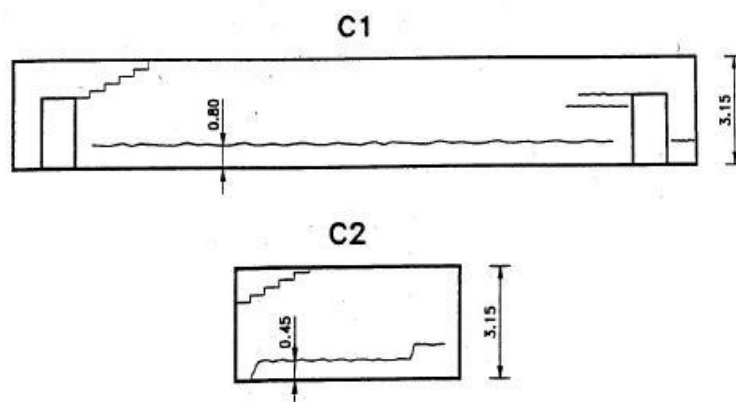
Effetti dell'eccessiva deformabilità del solaio intermedio sulle pareti divisorie longitudinali (C1) e trasversali (C2).
